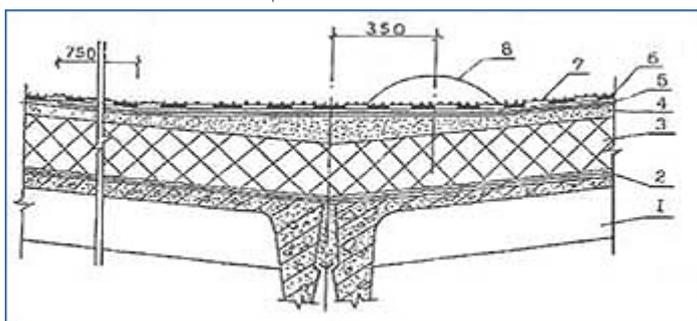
Ендова кровли: 1 - железобетонная плита покрытия; 2 - пароизоляция (по расчёту); 3 – теплоизоляция; 4 - цементно-песчанная стяжка; 5 - дополнительный слой кровли; 6 - основной кровельный ковёр; 7 - крупнозернистая посыпка верхнего слоя наплавляемого рулонного материала; 8 - воронка внутреннего водостока.
